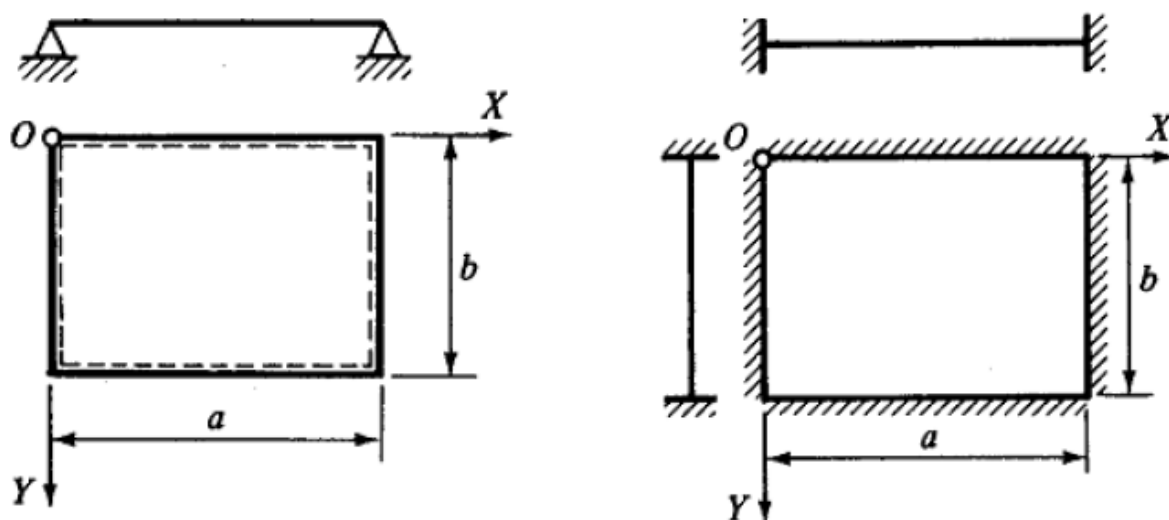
Tipos de apoios: (a) apoio simples e (b) apoio engastado.
